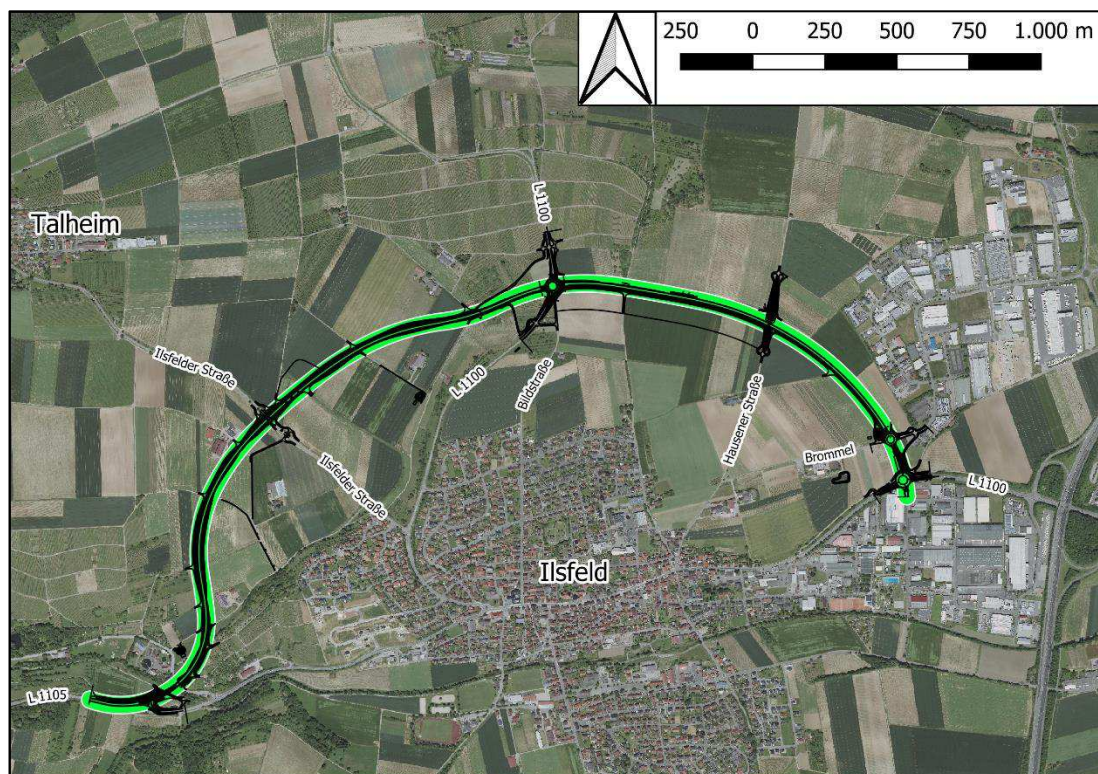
Übersichtslageplan der geplanten Ortsumfahrung Ilsfeld
